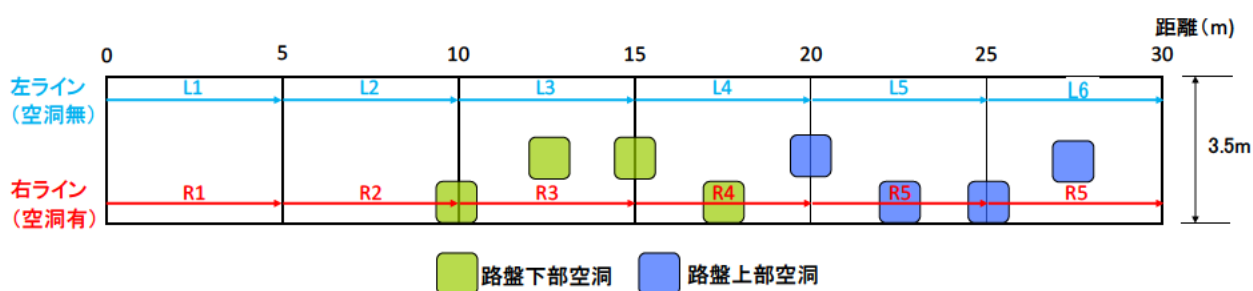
試験ヤード平面図（緑：路床直上空洞、青：Co 版直下空洞）
